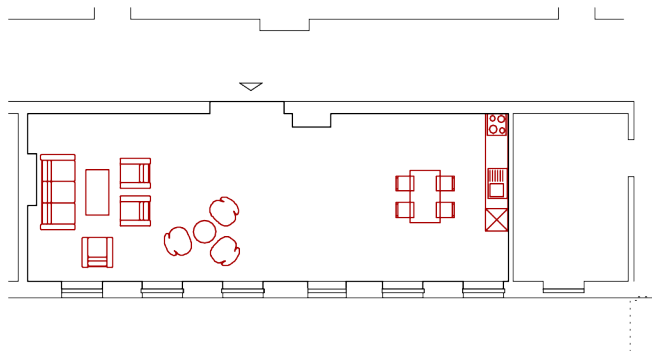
Grundriss hausgemeinschaftlicher Raum,
